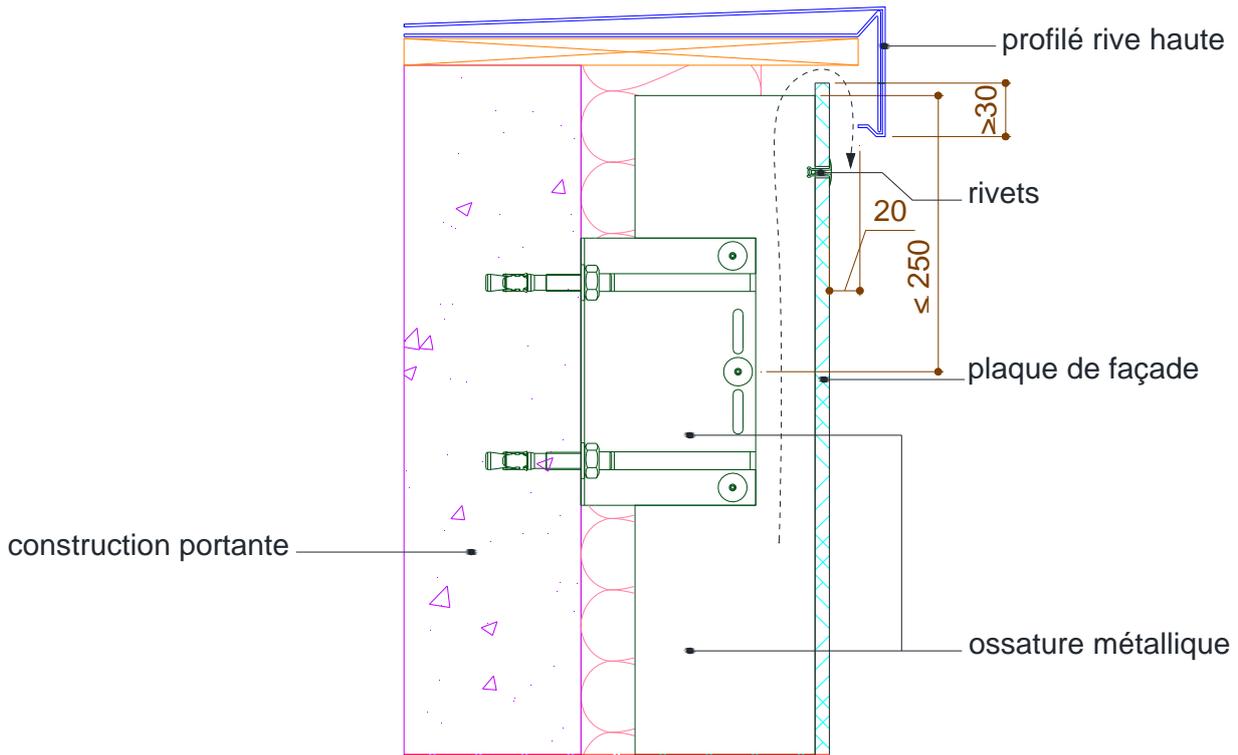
Détail arrêt sur acrotère sur ossature métallique (cote en mm)
